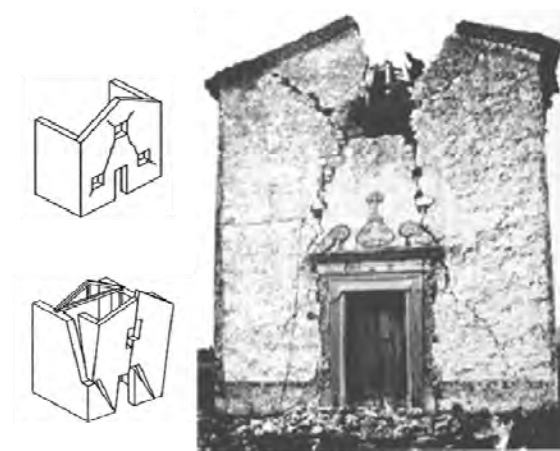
Mecanismo 3 - Fissuração por acção de corte no plano da fachada [Lagomarsino, 2007]
